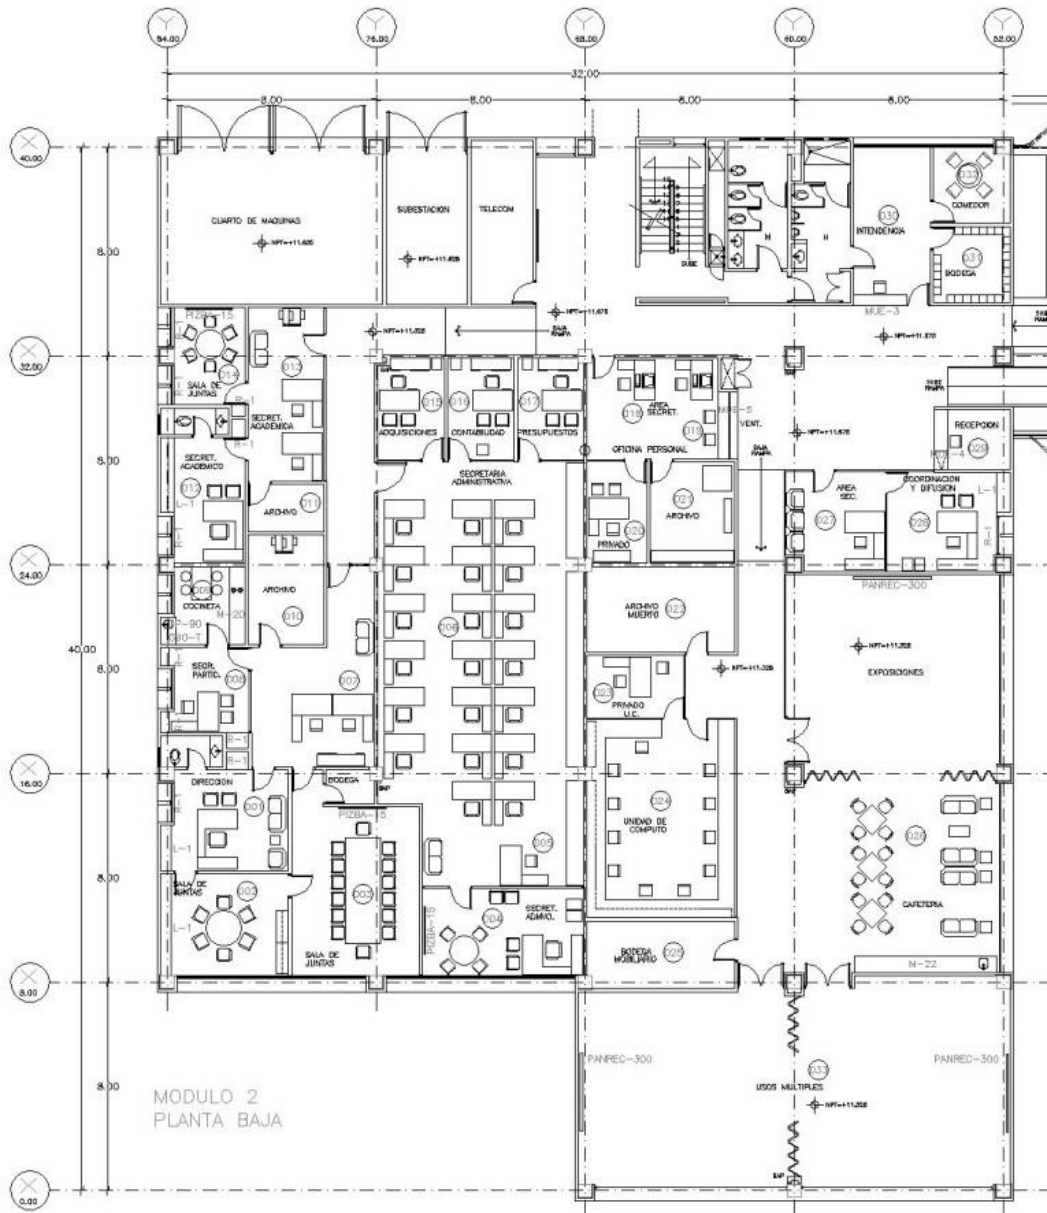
Módulo 2 planta baja. Recuperada de planos originales.
